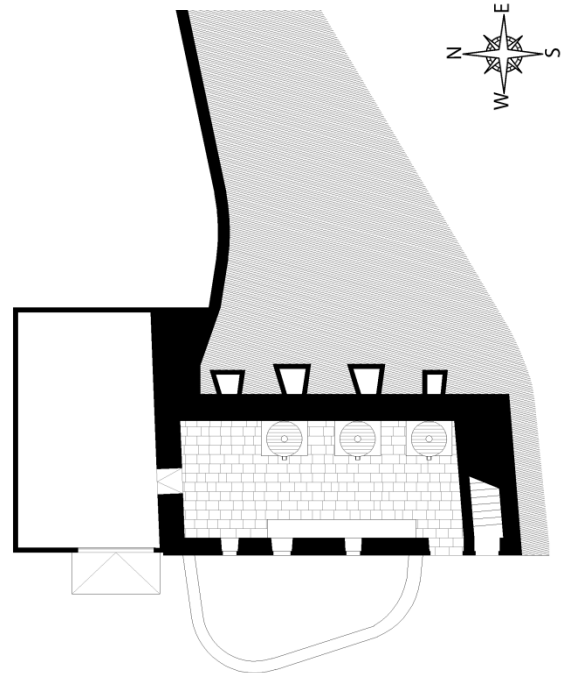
Planta do Rés-do-Chão (Fonte: do autor)
